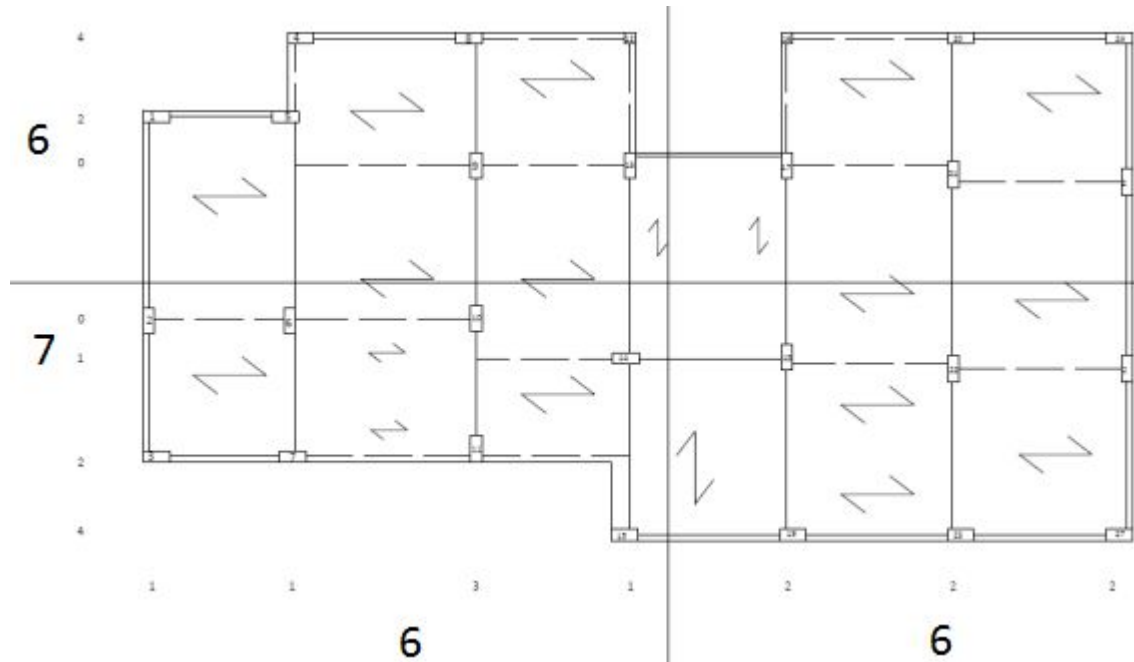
Distribuzione dei pilastri nella carpenteria tipo
